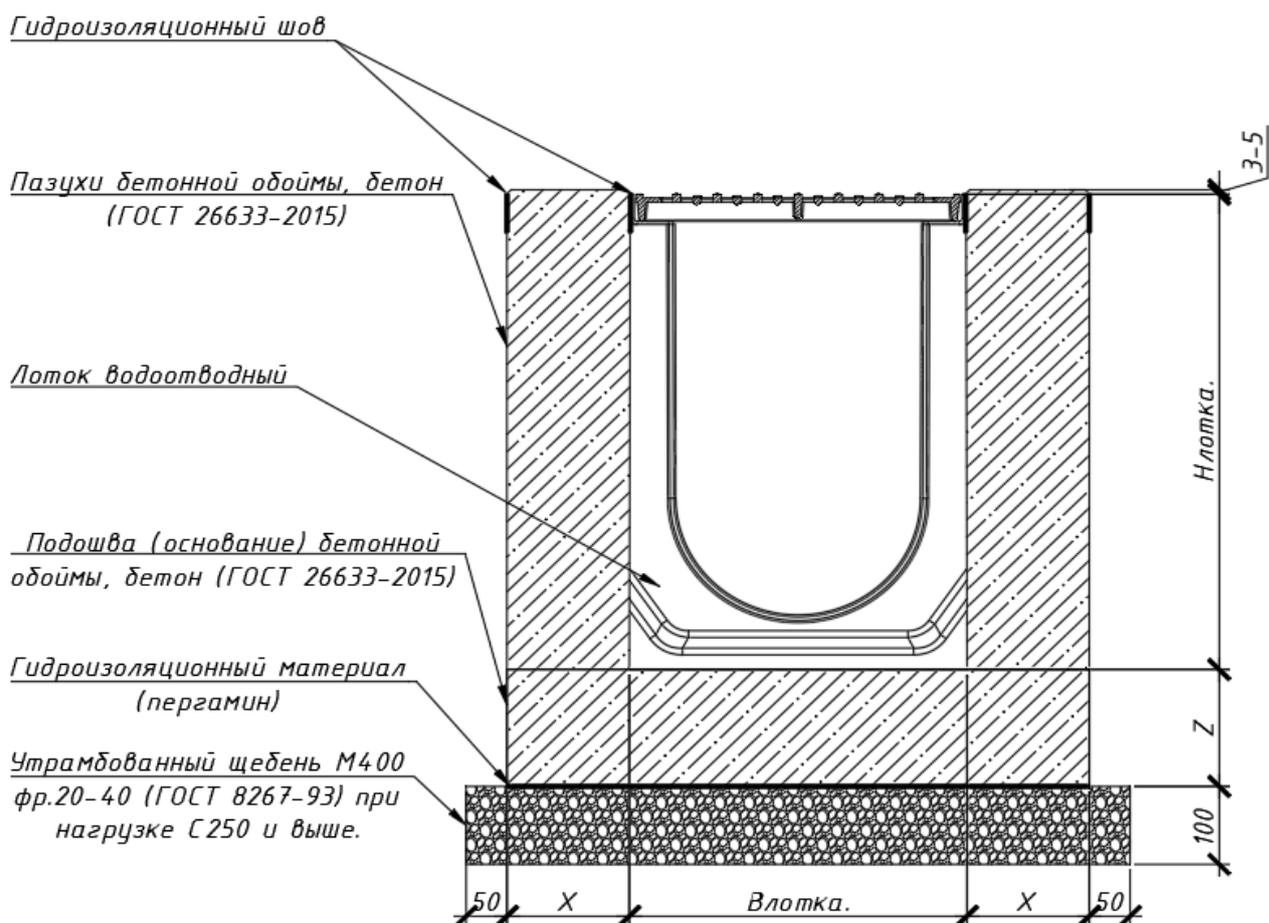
Схема монтажа бетонного водоотводного лотка.
